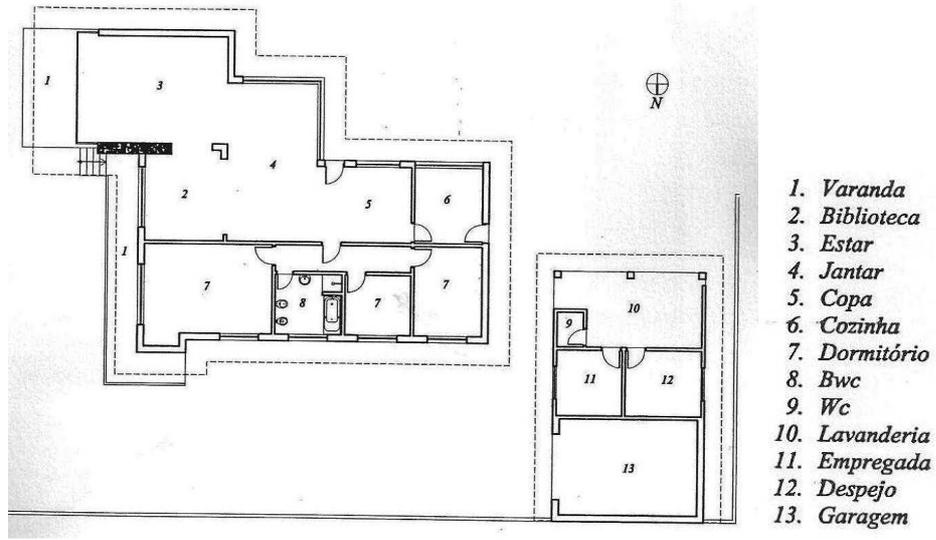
Planta da Casa Milton Menezes, Londrina, arquiteto Vilanova Artigas, 1952.
